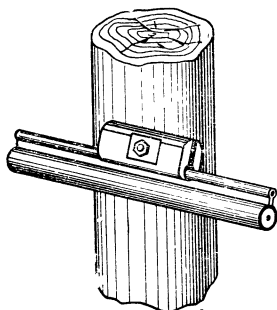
Крепление кабеля ВКПАПт к опоре
